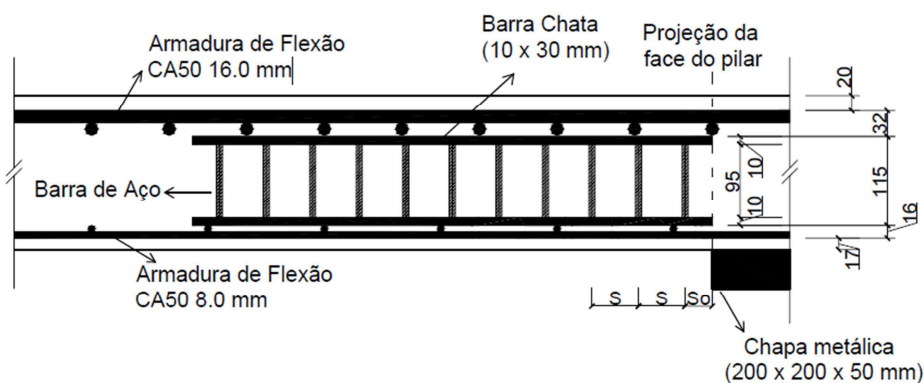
Desenho esquemático do posicionamento da armadura de cisalhamento (Trautwein, 2006)
